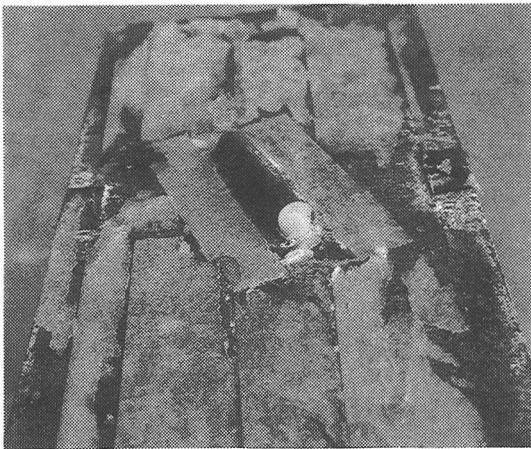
スラブ止め標準試験体の疲労破壊状況（鋼柱側）
